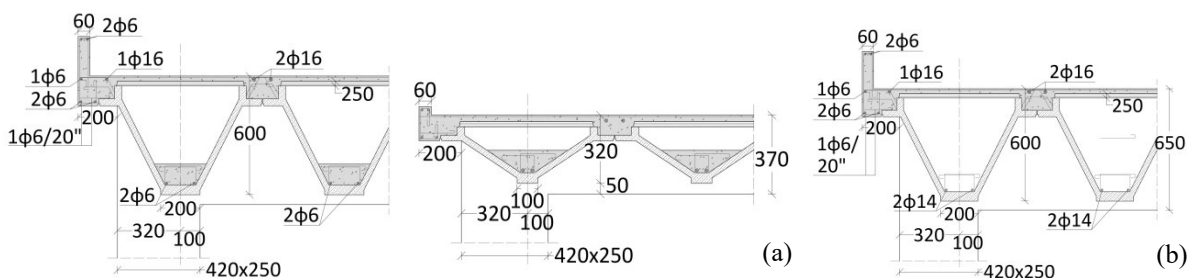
Travi prefabbricate di copertura a sezione variabile di tipo 1 (a), e a sezione costante di tipo 2 (b)
